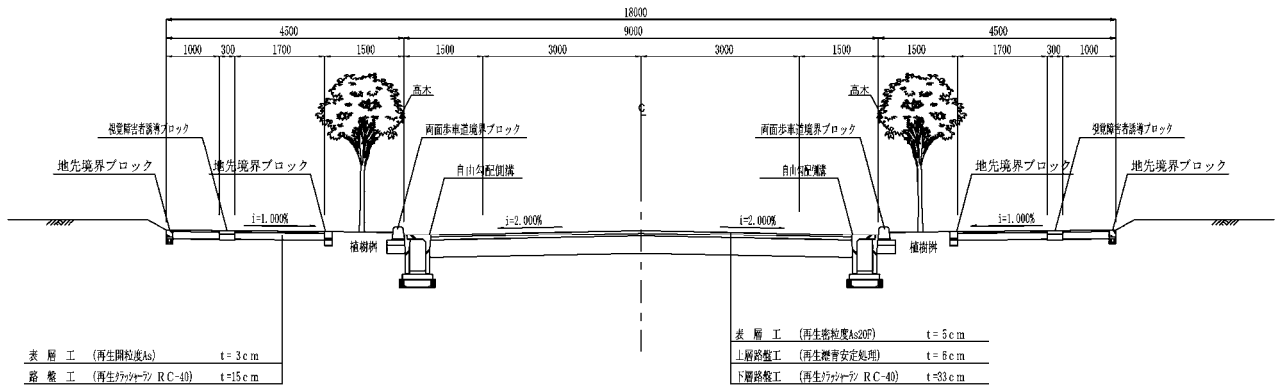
(1) 道路標準断面図(幹線道路:18m)
